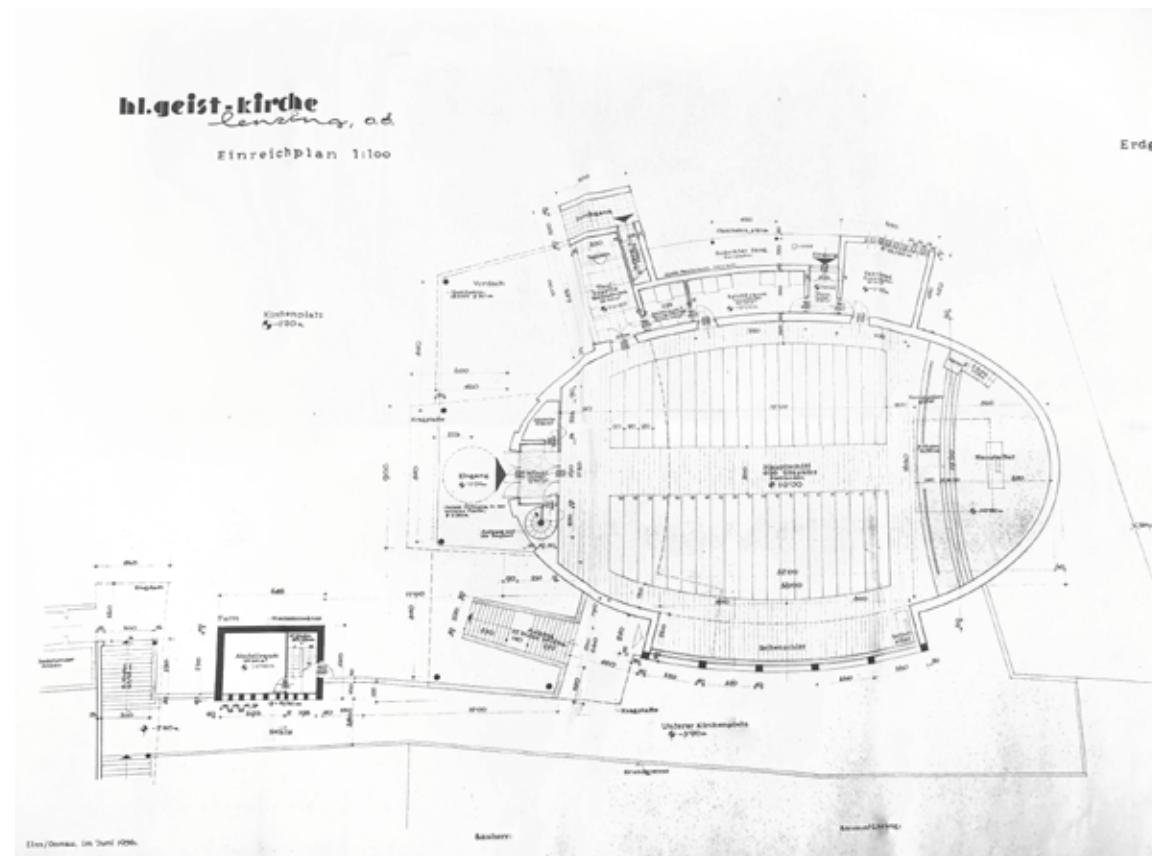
Einreichplanung 1956 Grundriss
